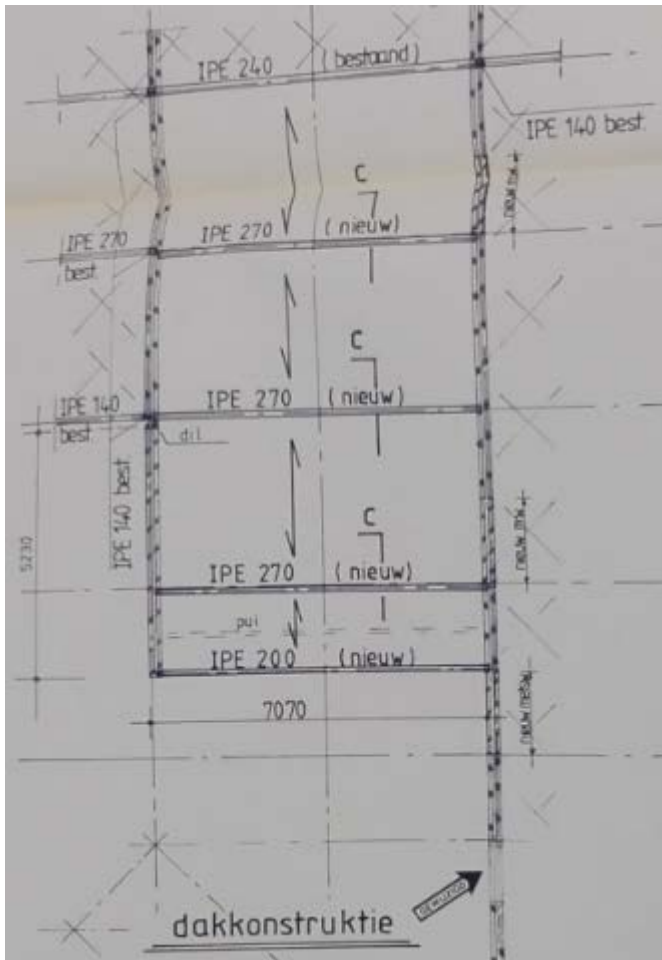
| Overzicht staalconstructie dak door A. v. Eck d.d. 13-01-1975.
